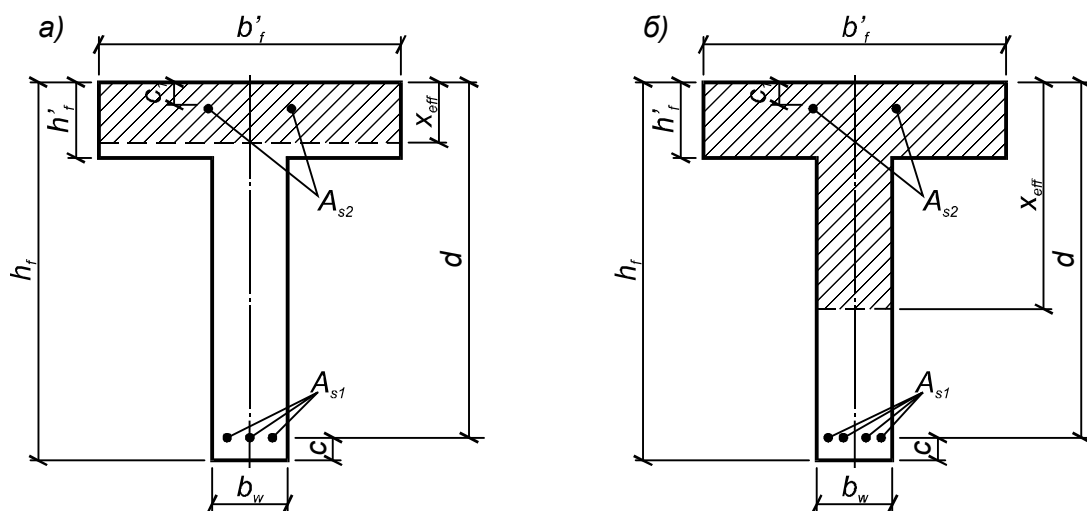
Положение границы условной сжатой зоны в сечении изгибаемого железобетонного элемента
